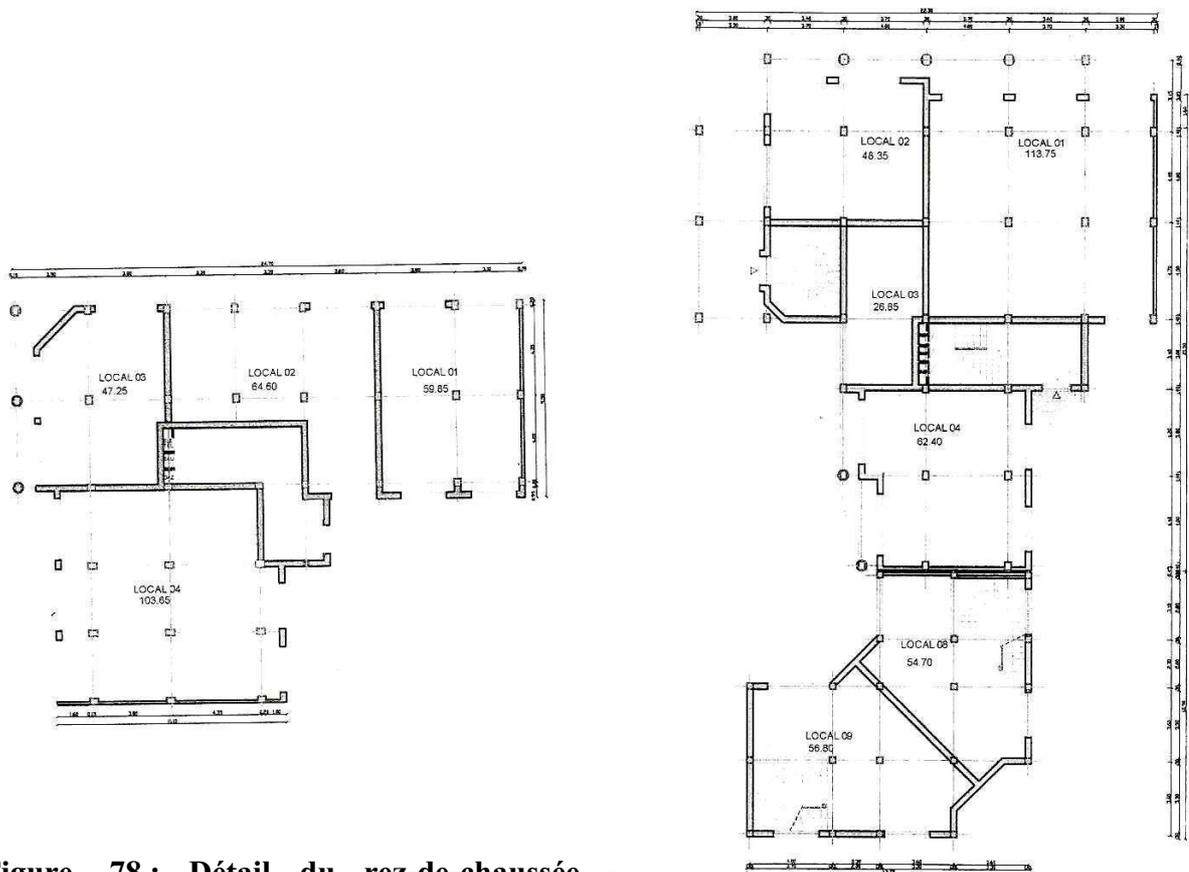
Détail du rez-de-chaussée - échelle : 1/400 -
